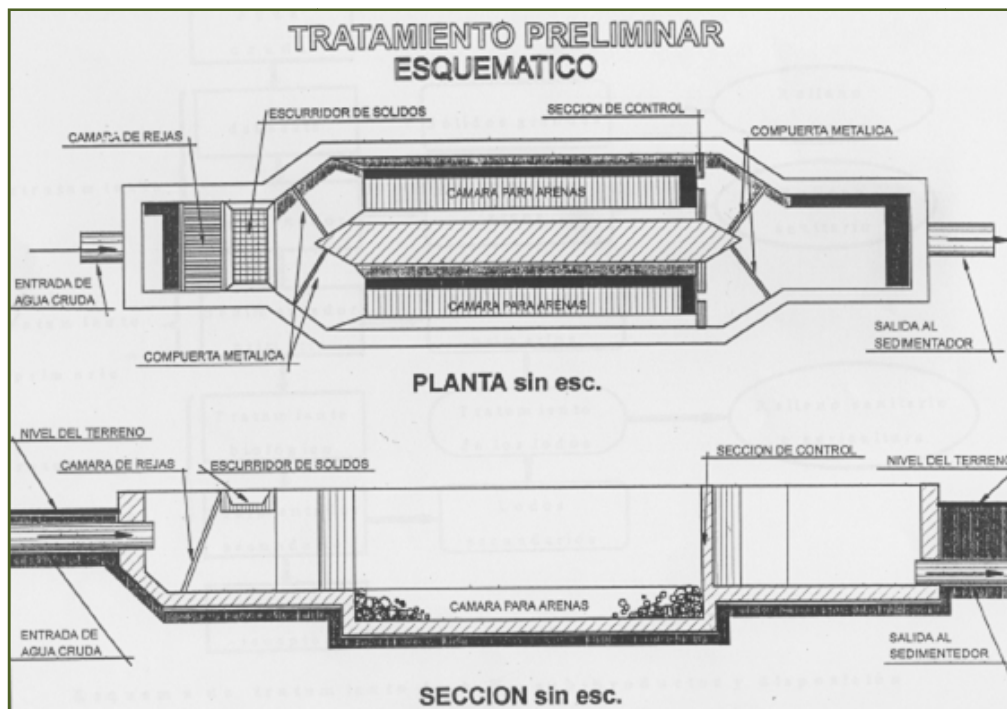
Vistas de corte longitudinal y planta de desarenador
